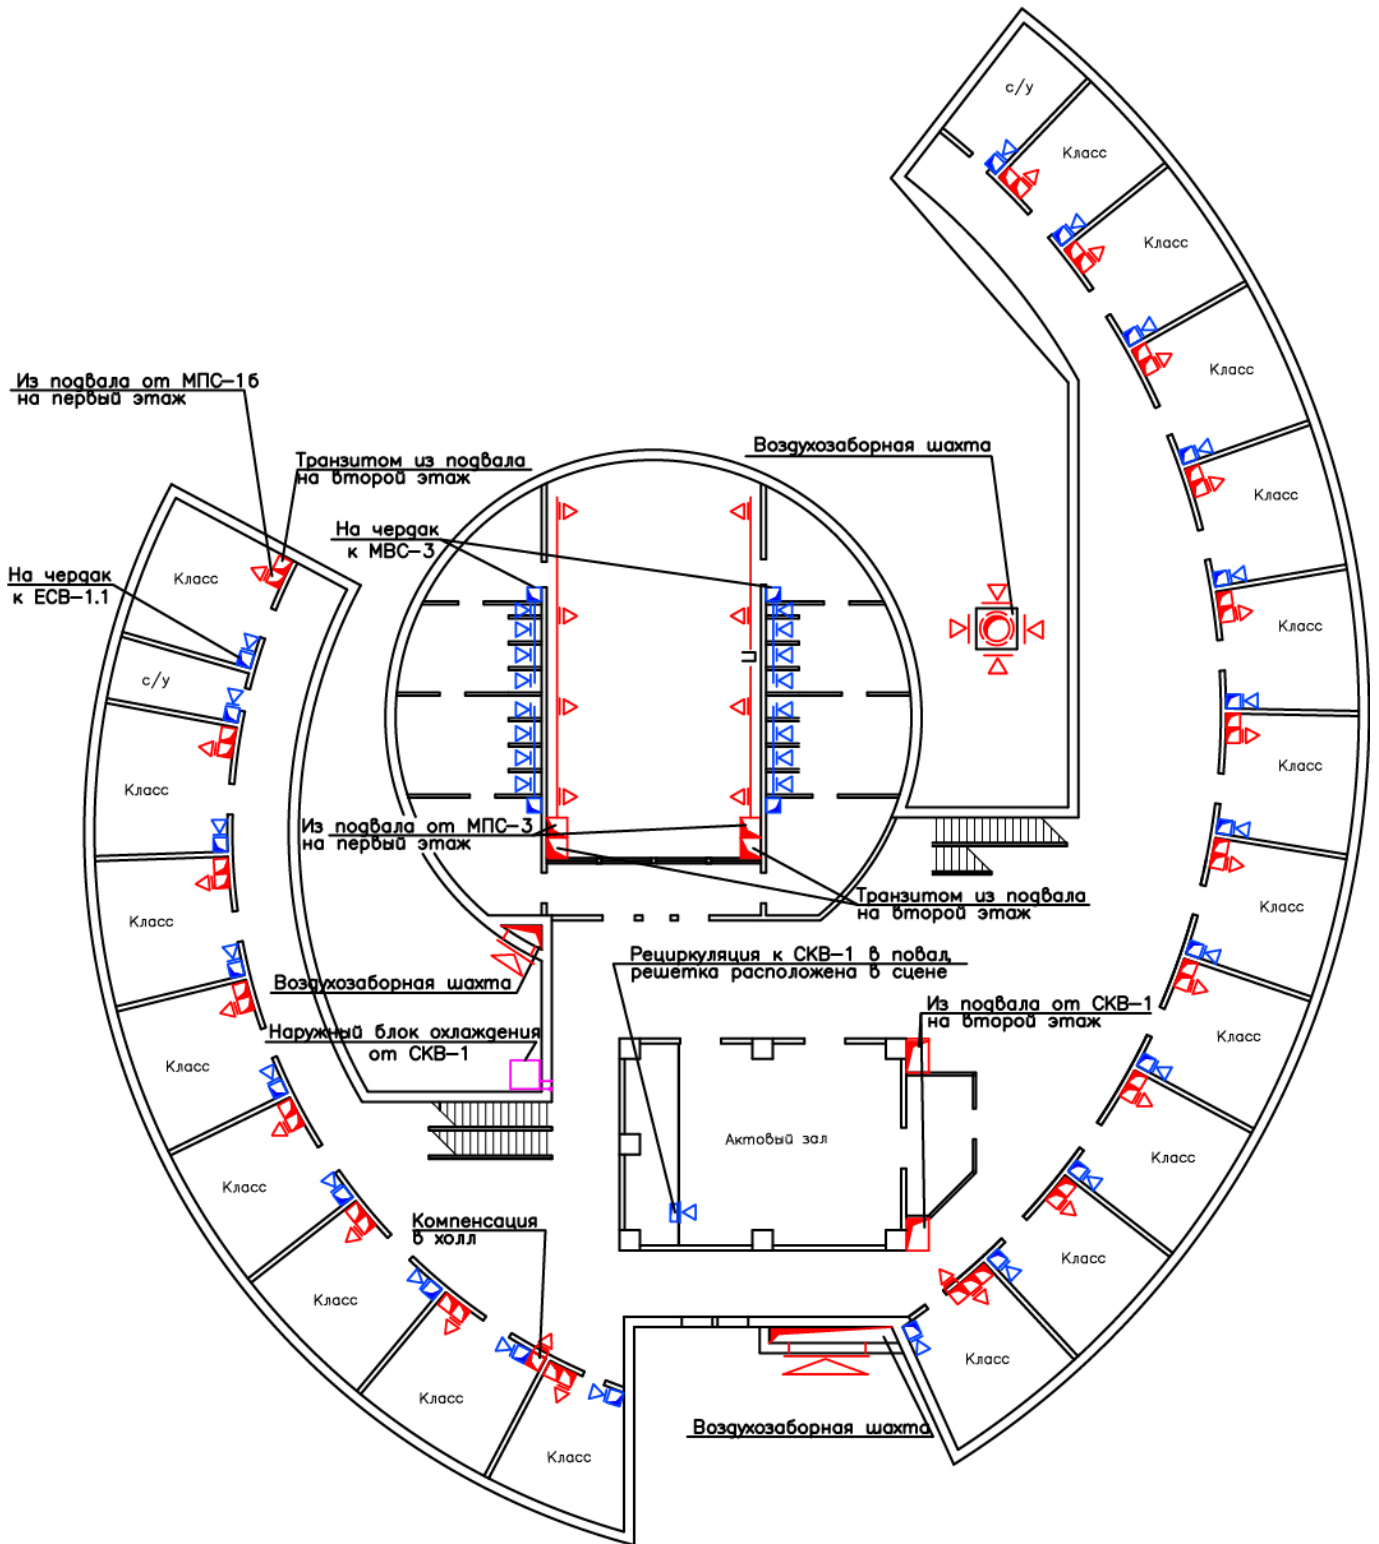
Рисунок III Пример размещения оборудования, воздухозаборных устройств и воздуховодов систем вентиляции и кондиционирования на первом этаже здания школы
